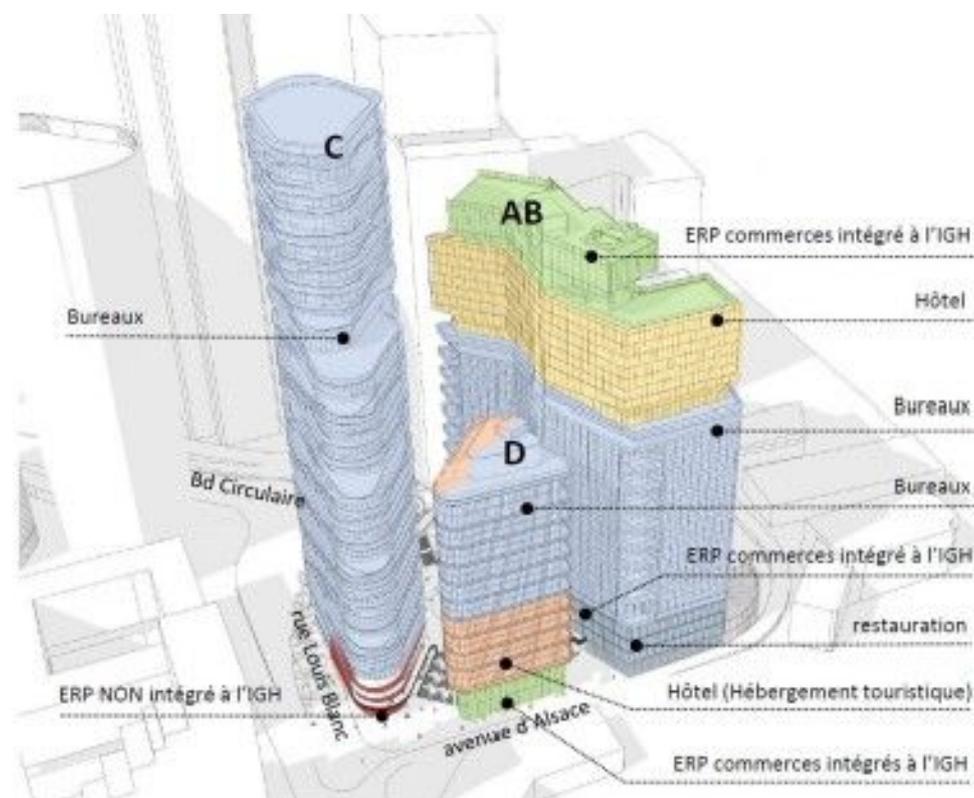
Plan du projet "les Miroirs" - Etude d'impact p.185
